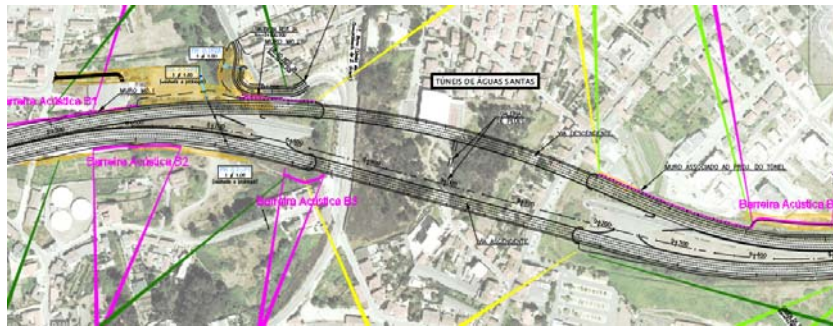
Planta de implantação prevista no projeto inicial de 2009 (fonte EIA)
